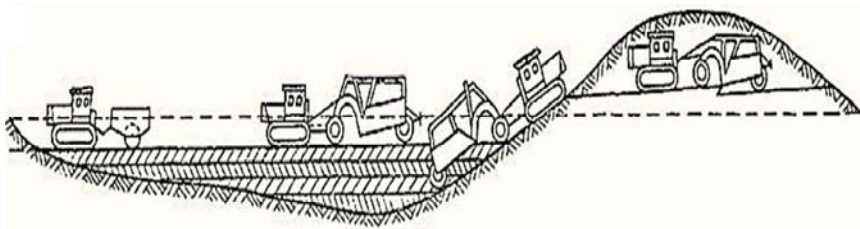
Схема перемещение грунта скрепером из выемки в насыпь
